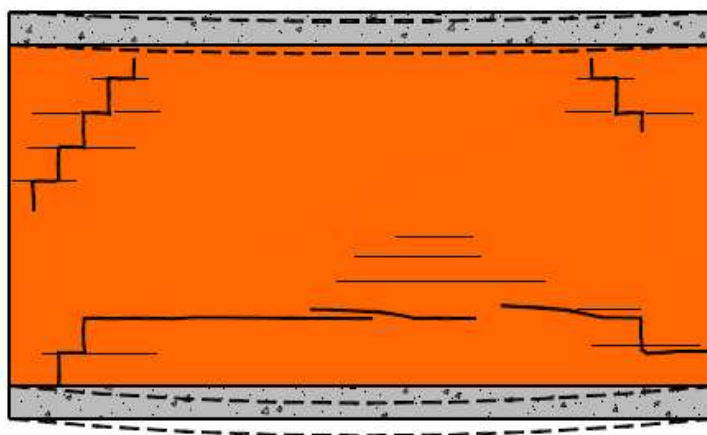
Fissuração devido á deformação do suporte: pavimento inferior mais deformável que o superior.[10]
